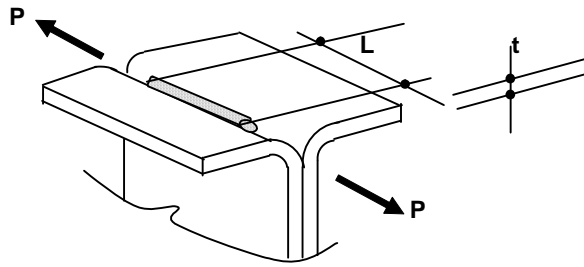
Soldadura a tope acampanada en V cargada longitudinalmente.
